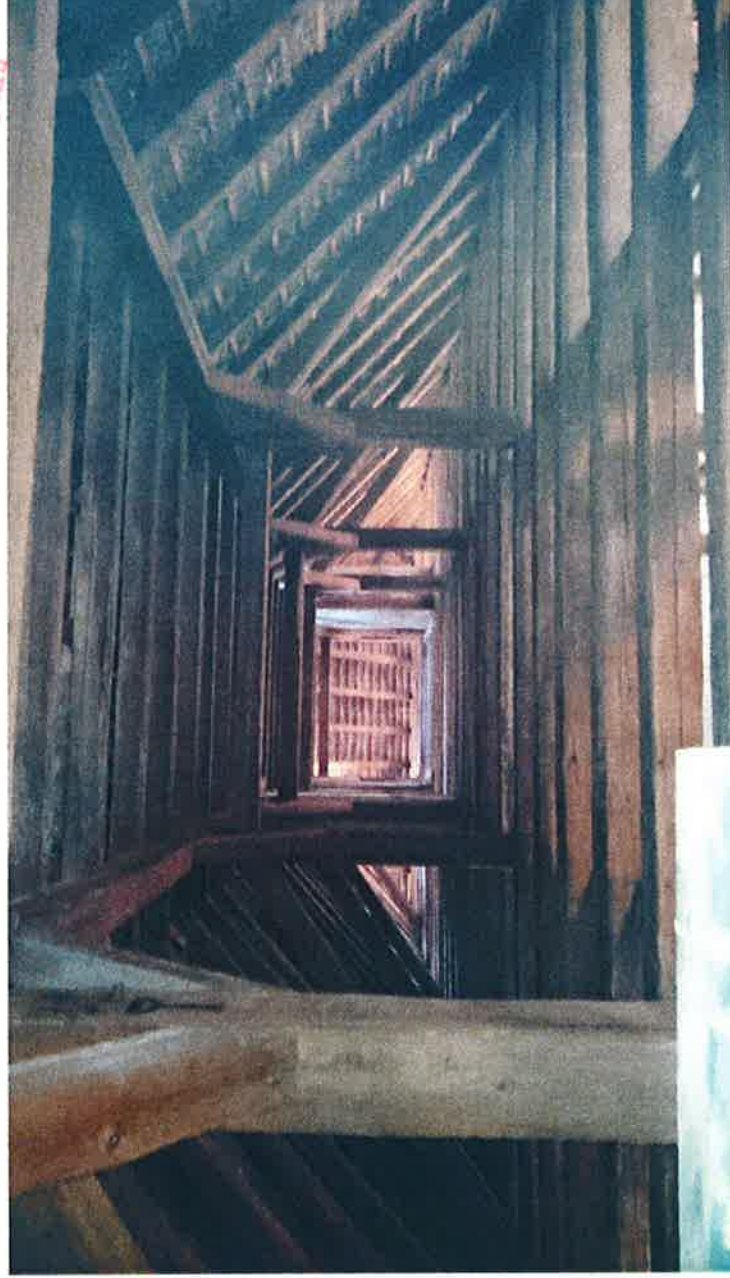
Widok więźby dachowej – widok ścian stolcowych
